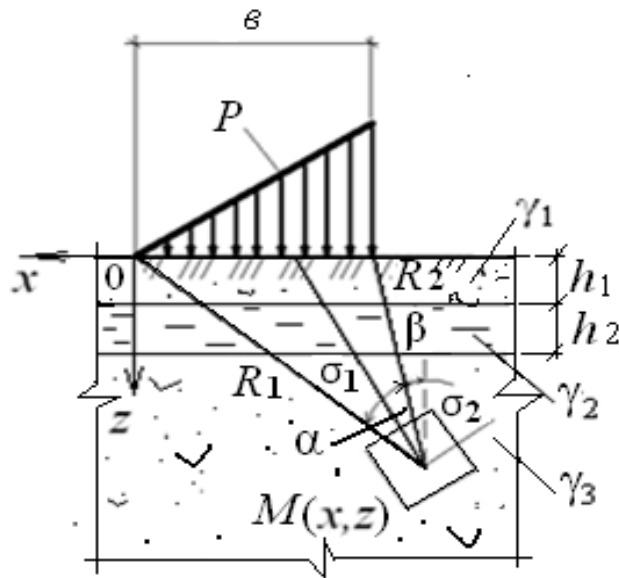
Модель многослойной грунтовой среды и эпюра треугольной нагрузки
